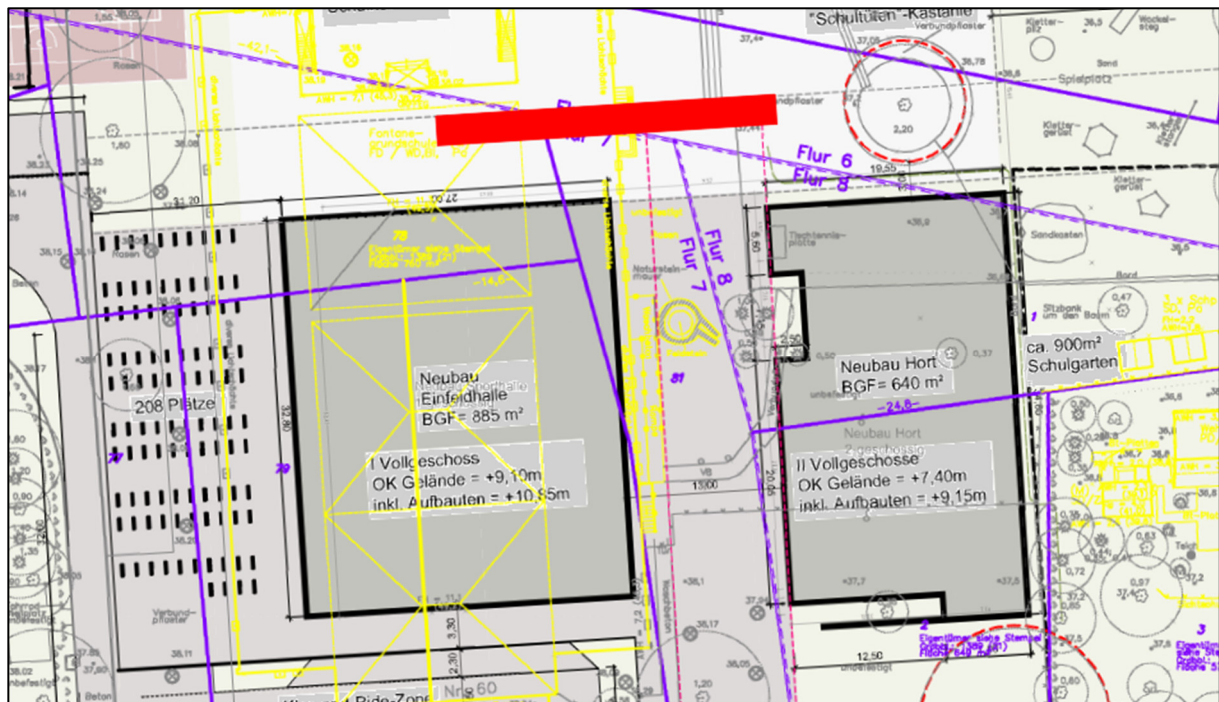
Lage Rigole Dachflächen – Neubau Einfeldsporthalle und Hort Außenanlagenplanung Variante 2
